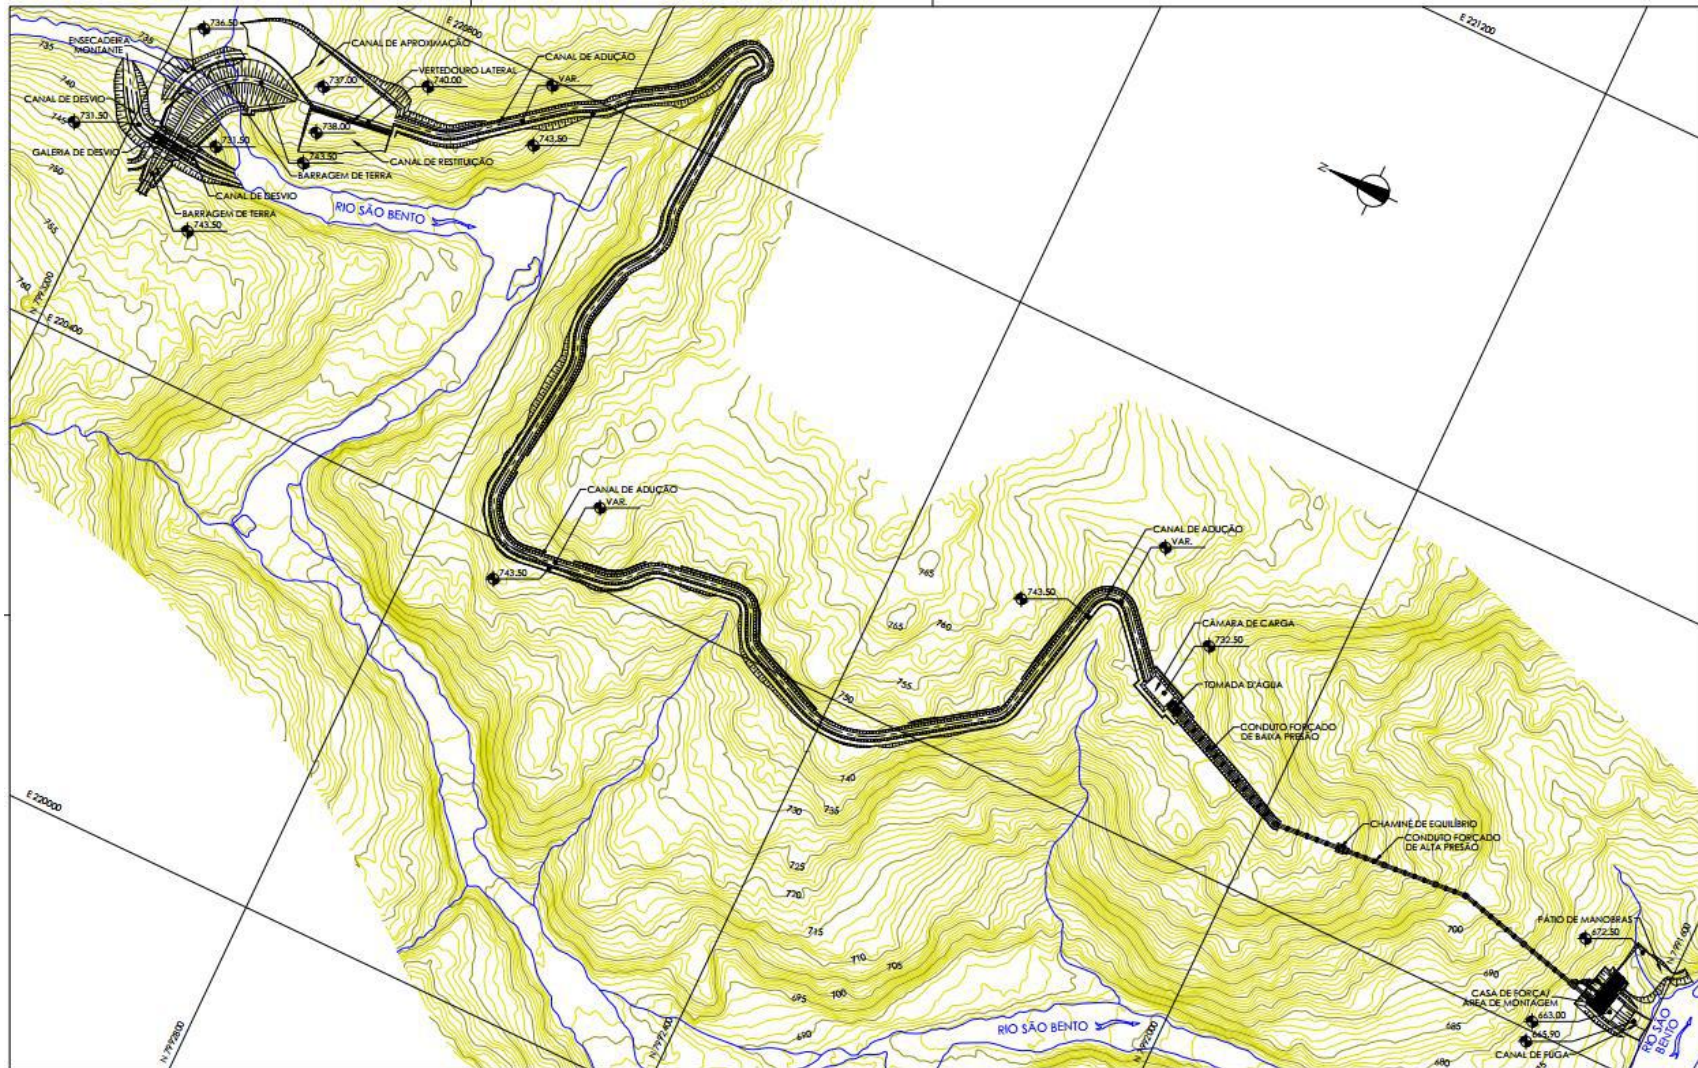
Arranjo geral das estruturas – Alternativa 1
